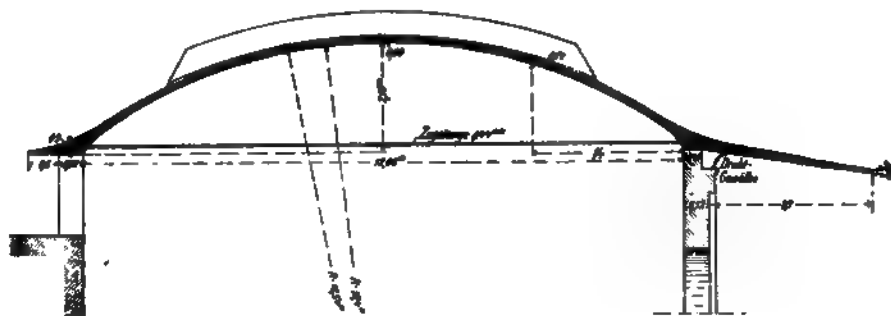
Bogendach-Querschnitt (zu Abb. 233).
